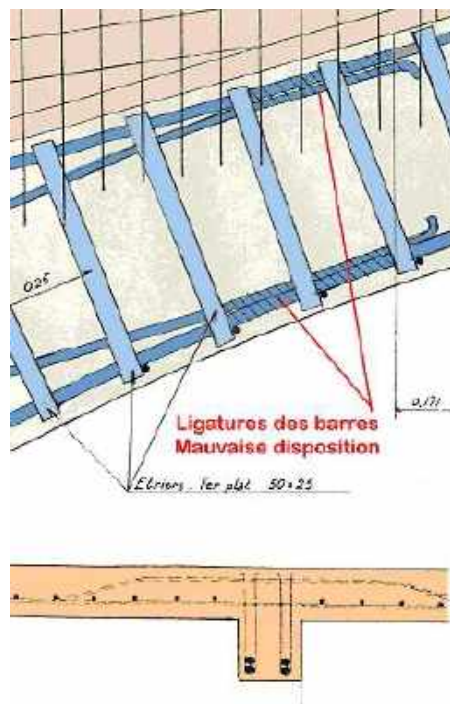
ferrailage Hennebique d'après les plans d'une passerelle à Auxerre des années 1910
